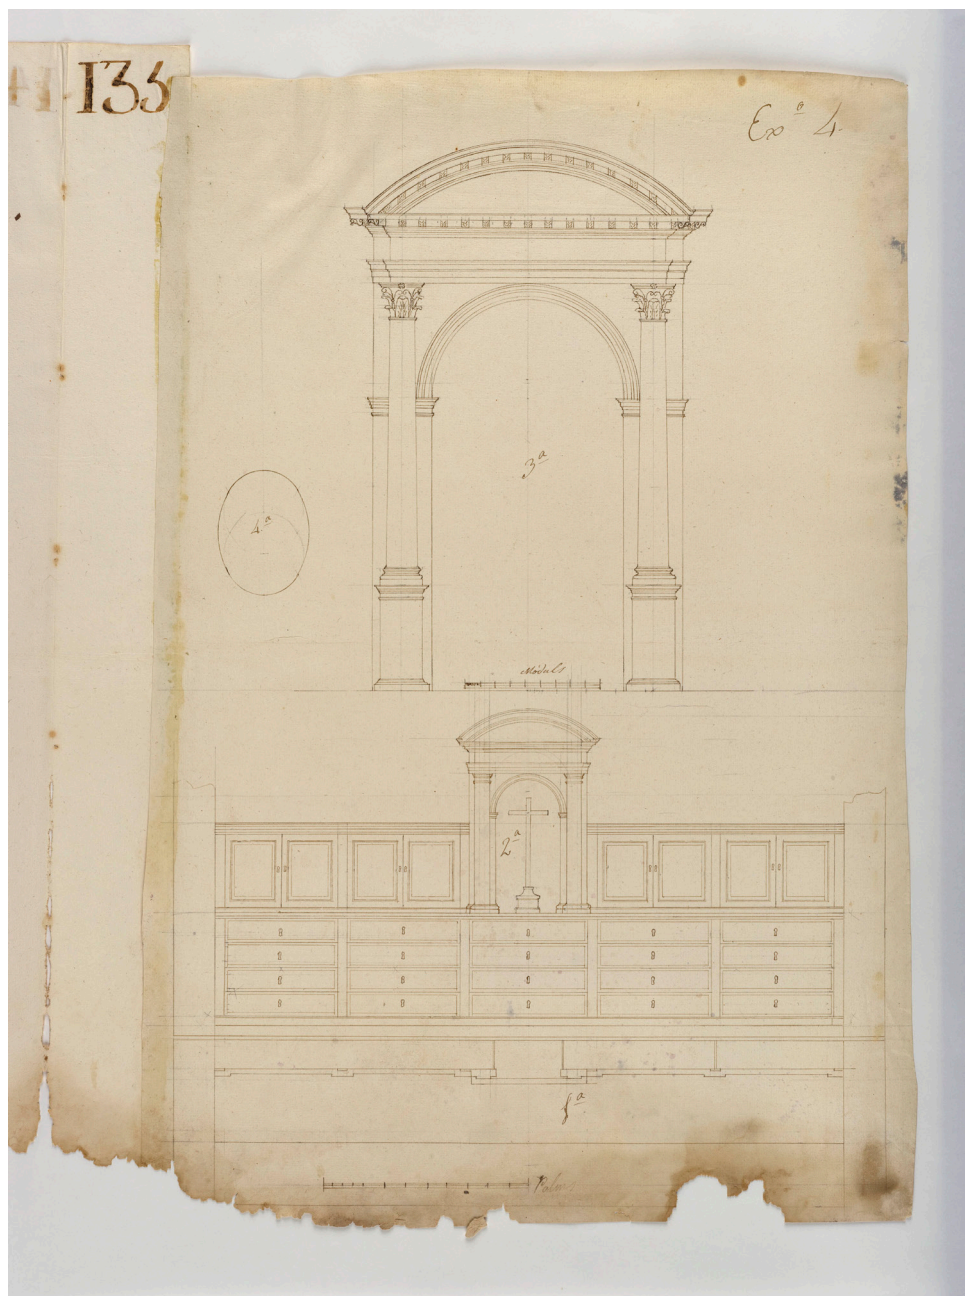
P. 135. Arco de triunfo. Cómoda de sacristía, planta y alzado. Óvalo.
